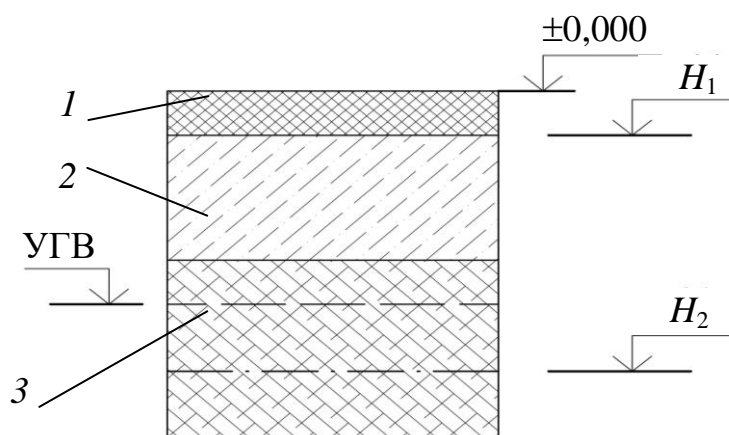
Геологический разрез строительной площадки: 1 – растительный слой; 2 – первый основной грунт; 3 – второй основной грунт; УГВ – уровень грунтовых вод
